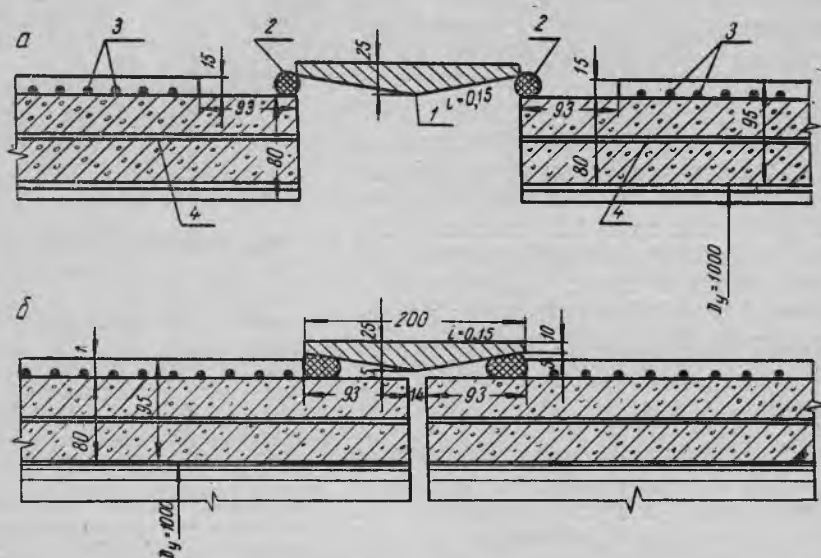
Муфтовый стык сборных предварительно напряженных железобетонных трубопроводов:
